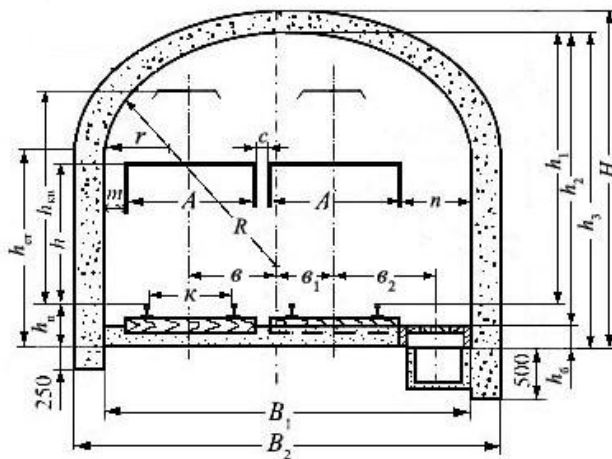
Поперечное сечение выработки с монолитной бетонной крепью
